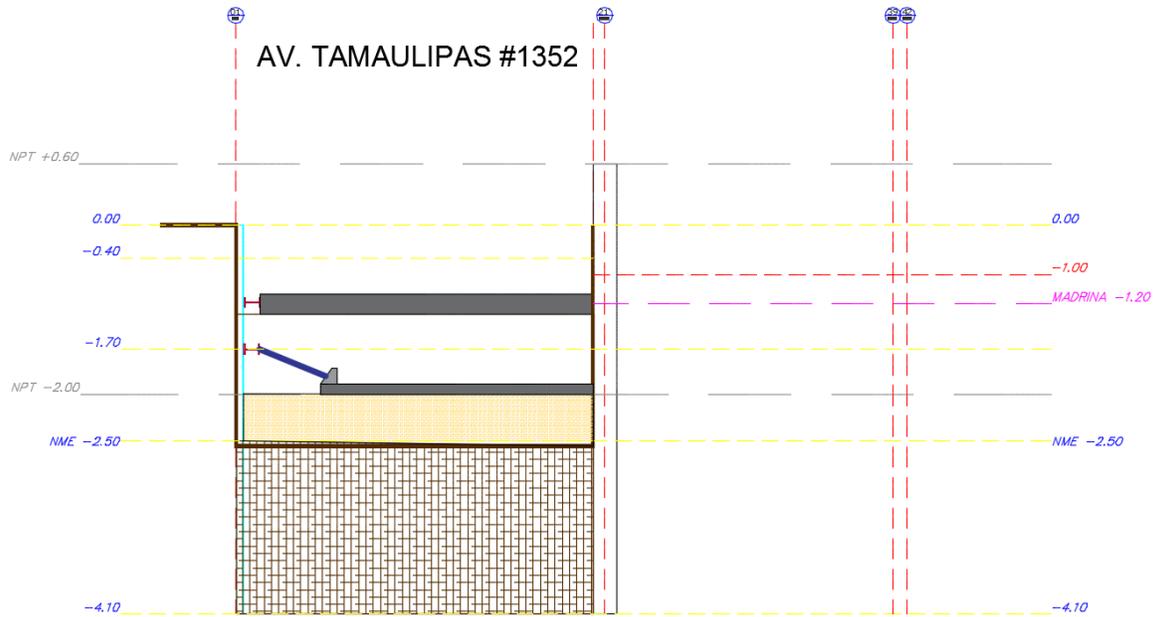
RETIRO DE MODULOS Y COLOCACIÓN DEL SEGUNDO NIVEL DE TROQUELES
